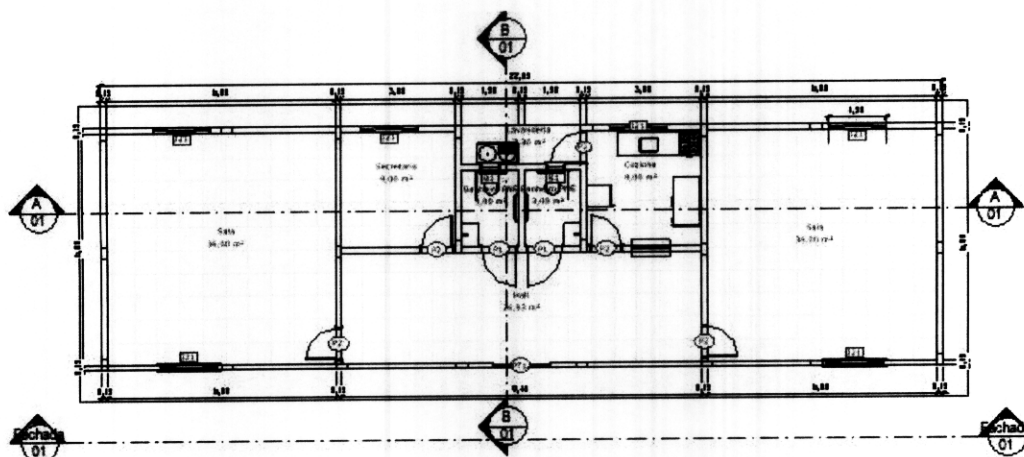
Projeto arquitetônico reprogramado com área construída de 138,91m²; planta baixa com as devidas alterações e dimensionamento.
